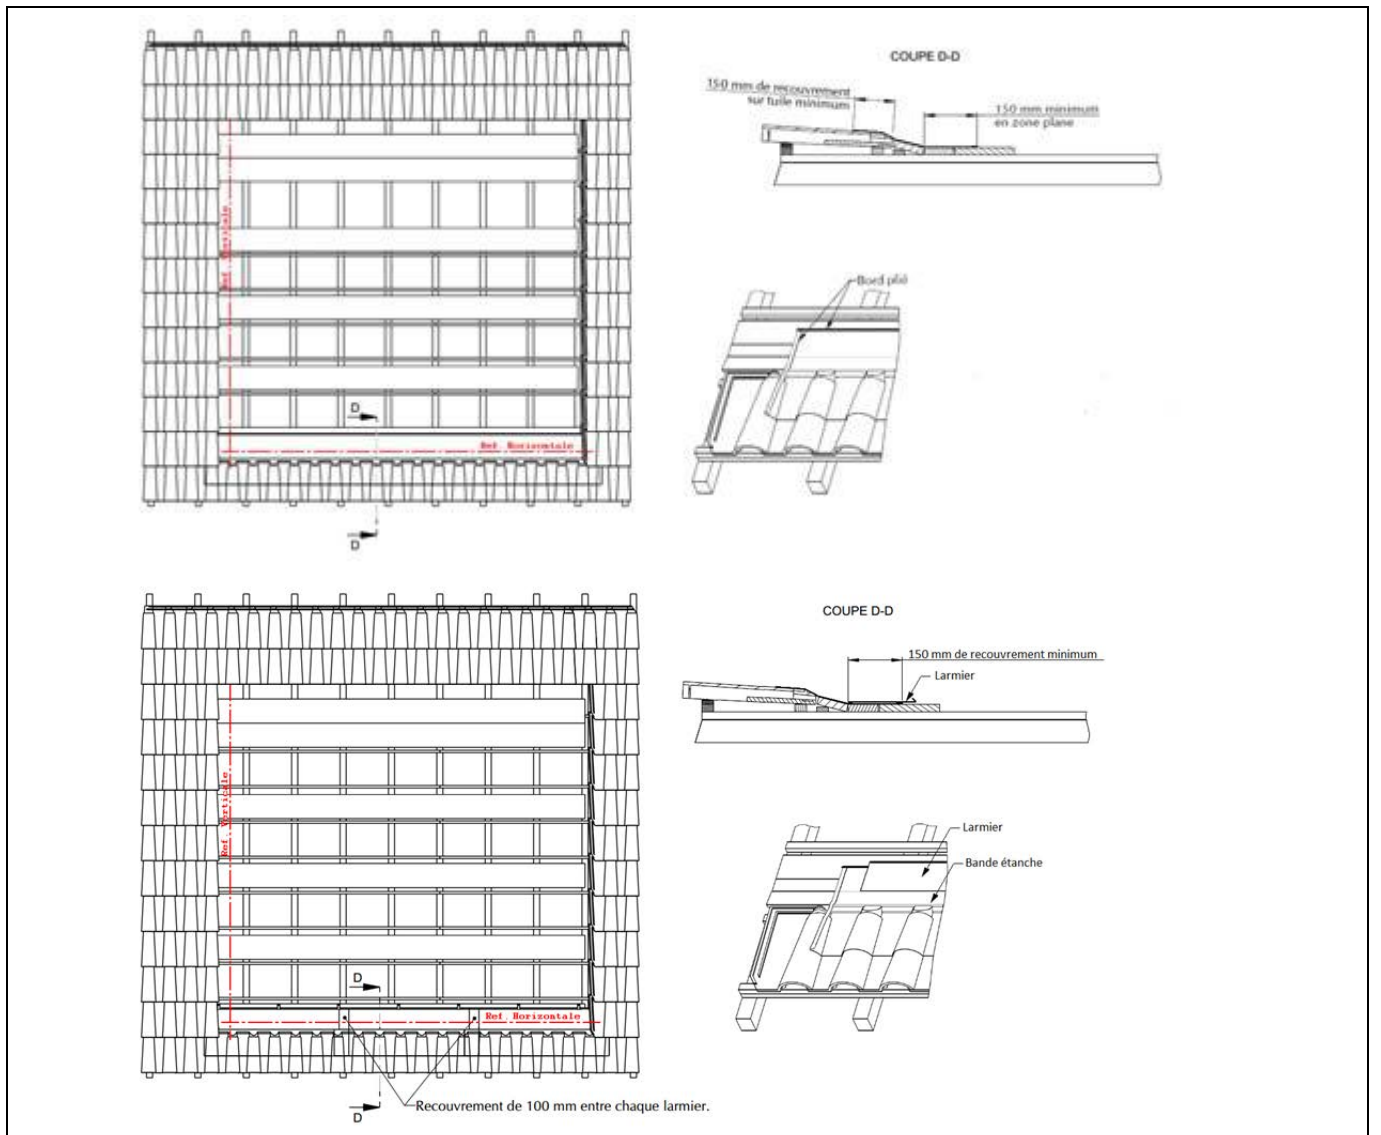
Pose de la bande d'étanchéité basse et des larmiers inférieurs
